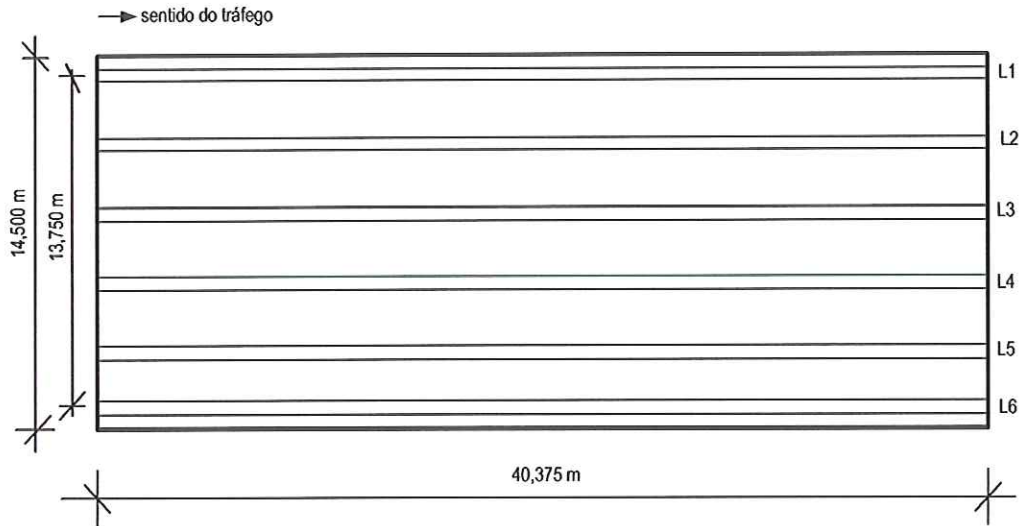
Dimensões do tabuleiro e distribuição das vigas
